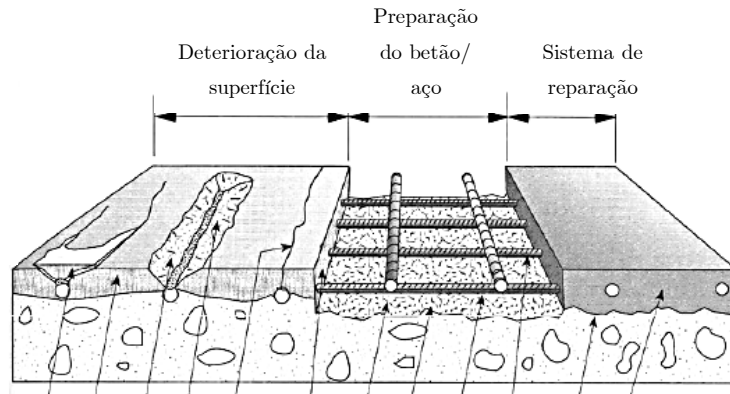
Estado deterioração(esq.) e reparação(dir.) de uma laje
